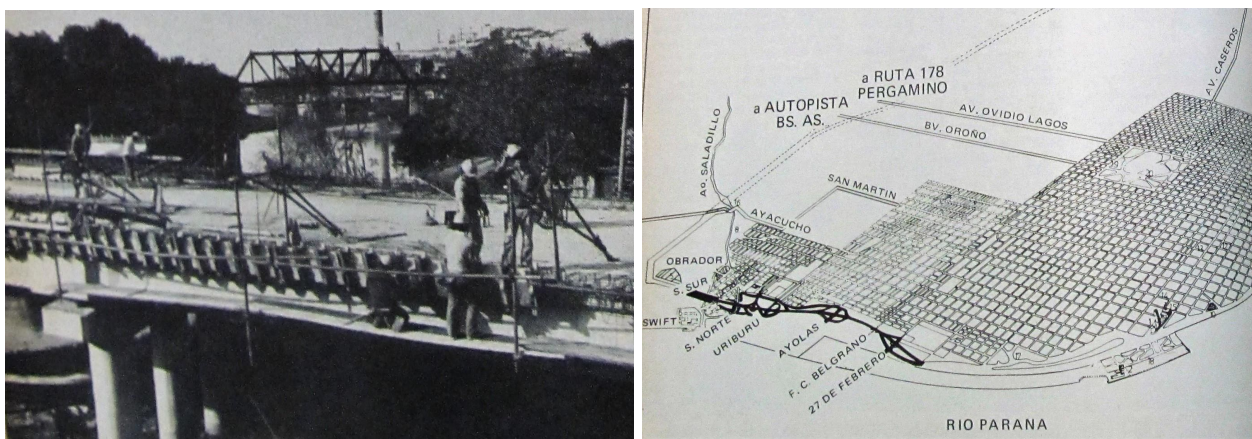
Detalle de la construcción del Acceso Sur y plano del Acceso Sur, Revista Vivienda, 1981.
